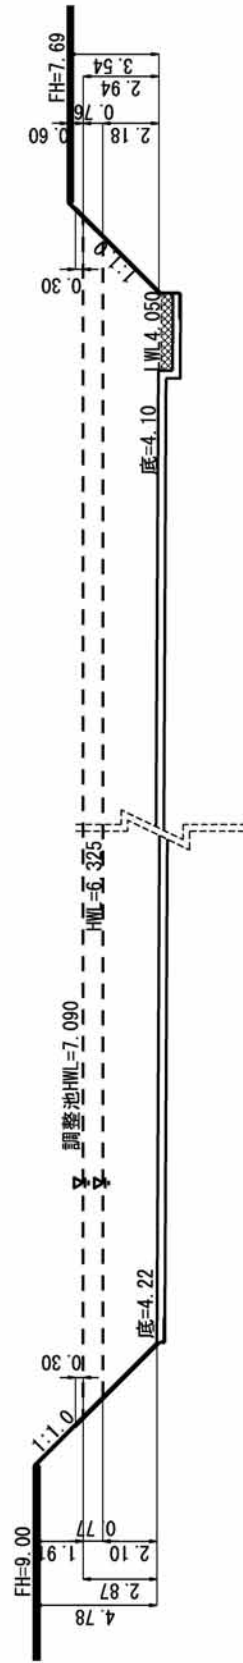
(3) 調整池計画平面・断面図 (第3調整池) 【第3回変更】
